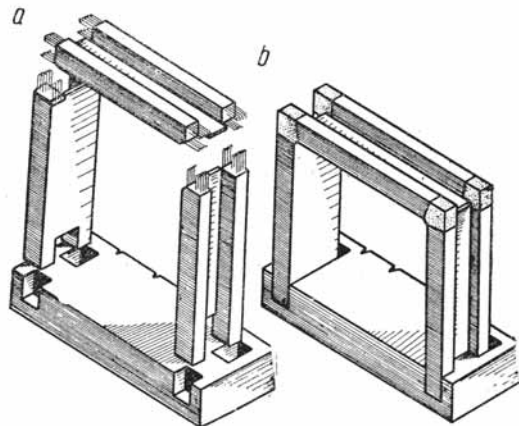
Typowy kolejowy przepust betonowy o konstrukcji otwartej [2]
